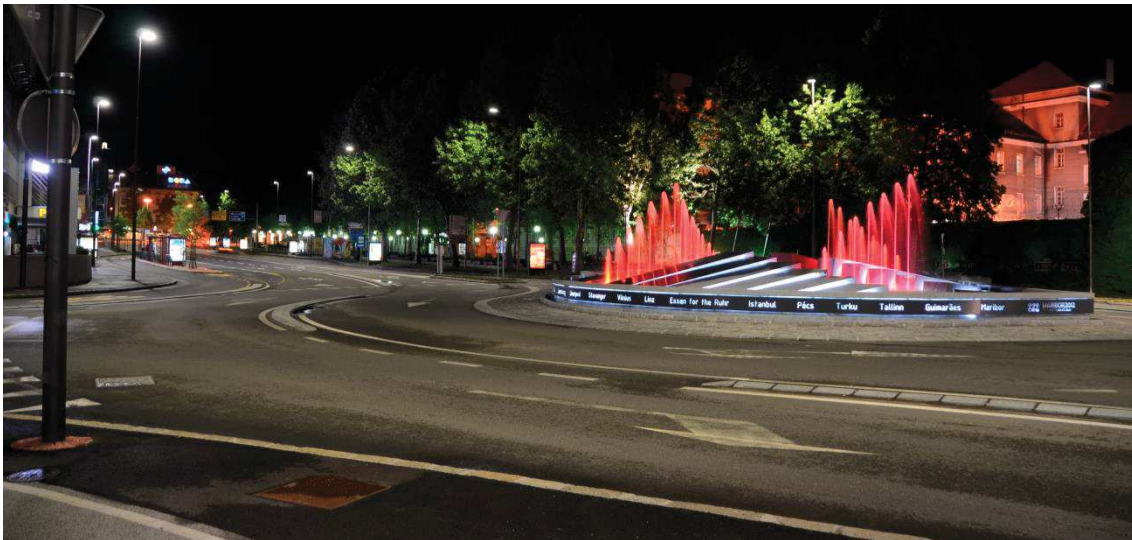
Oddělení jízdních pruhů před TOK v Mariboru
